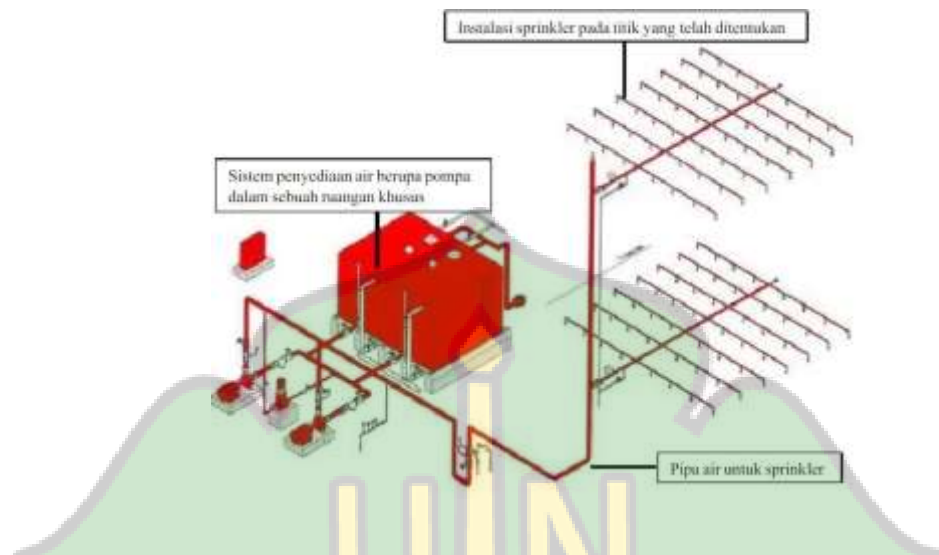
Skema instalasi sistem sprinkler pada bangunan
